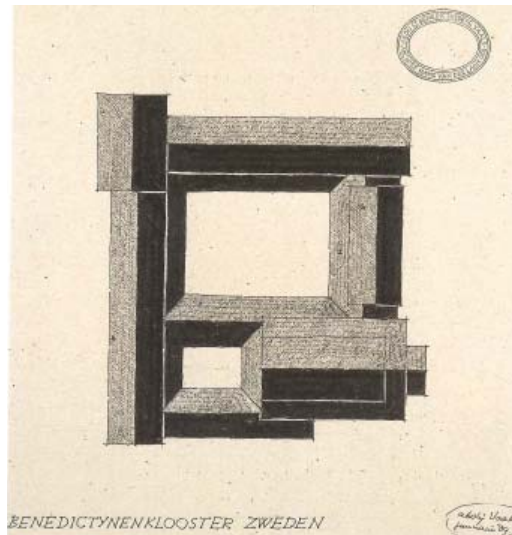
Planimetria di progetto del convento femminile parzialmente realizzato
